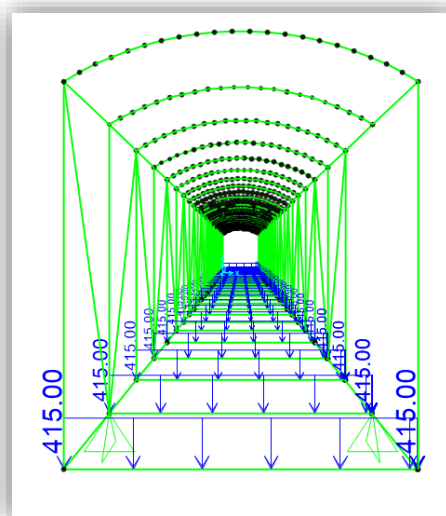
Vista en sección transversal de la estructura con carga viva (LIVE).
